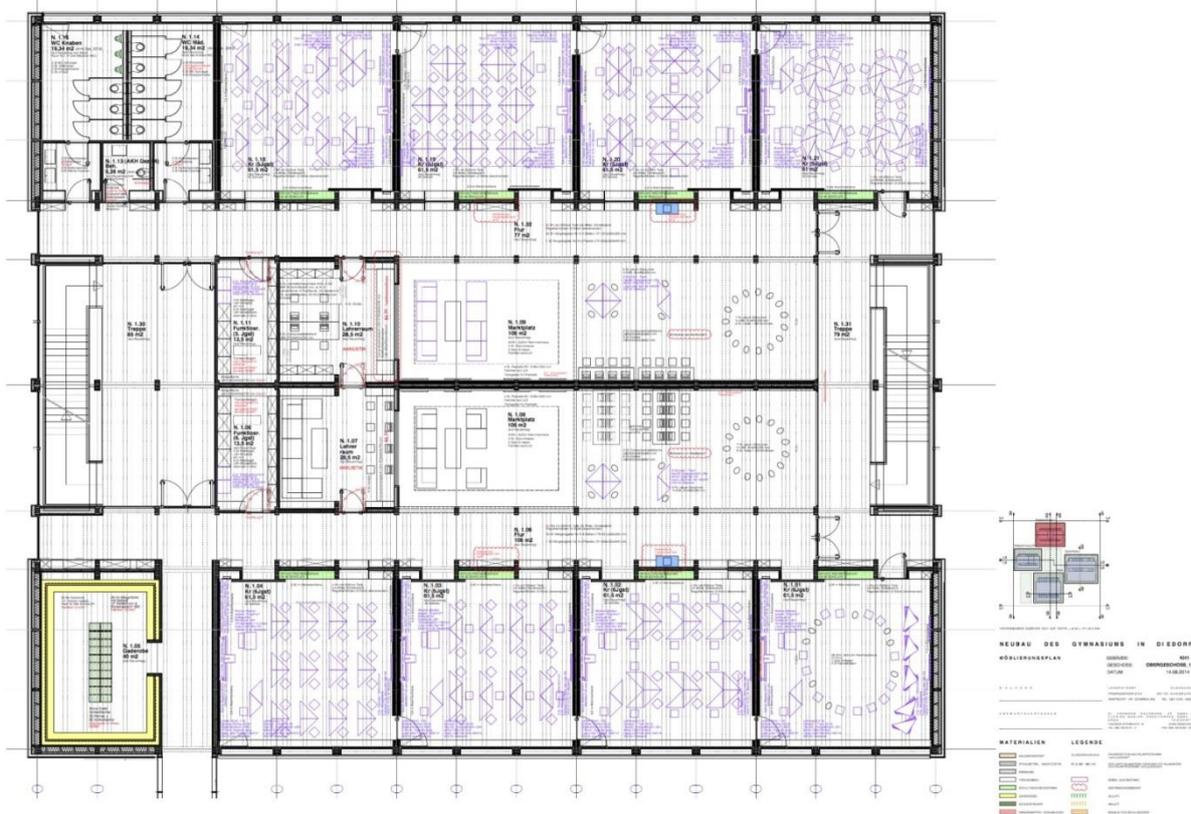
Umsetzung im Grundriss
